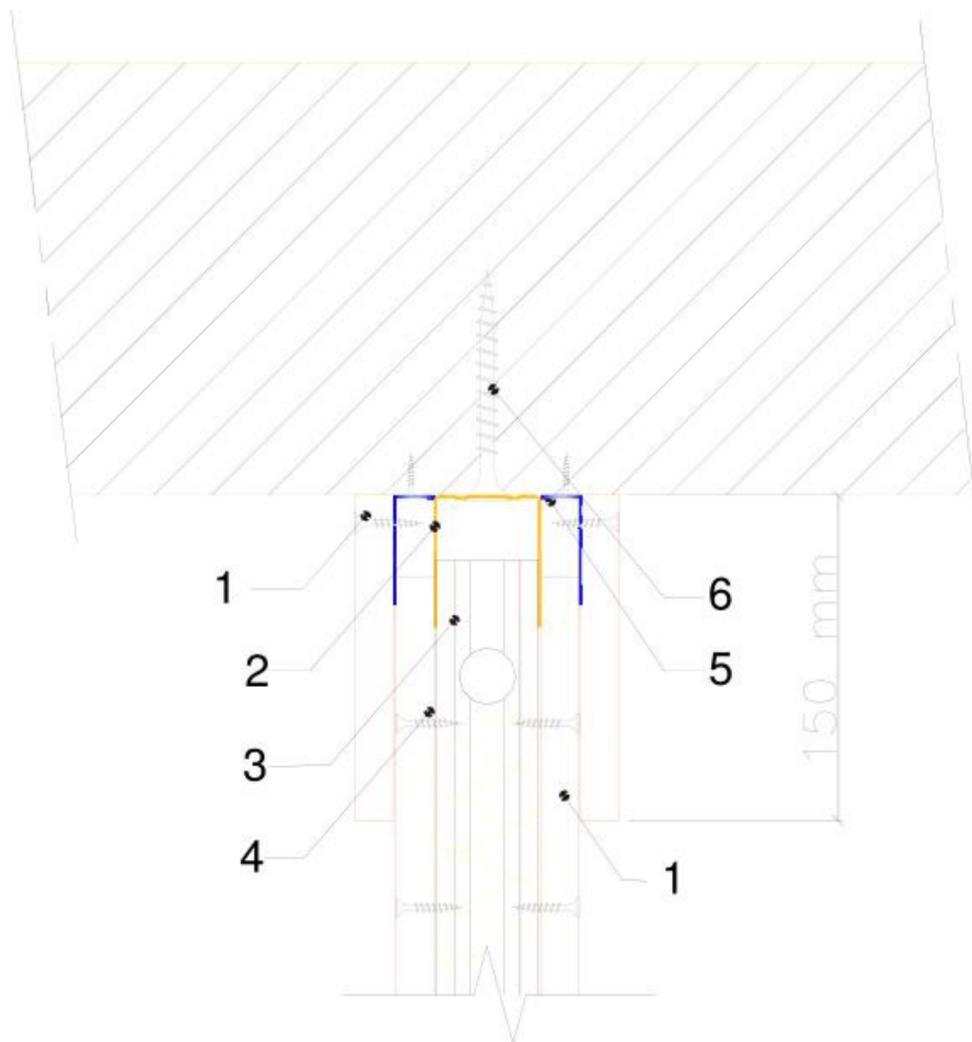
Cloisons : KHD BA18 98/62 ou Diamant 15 100/70 – Coupe verticale
